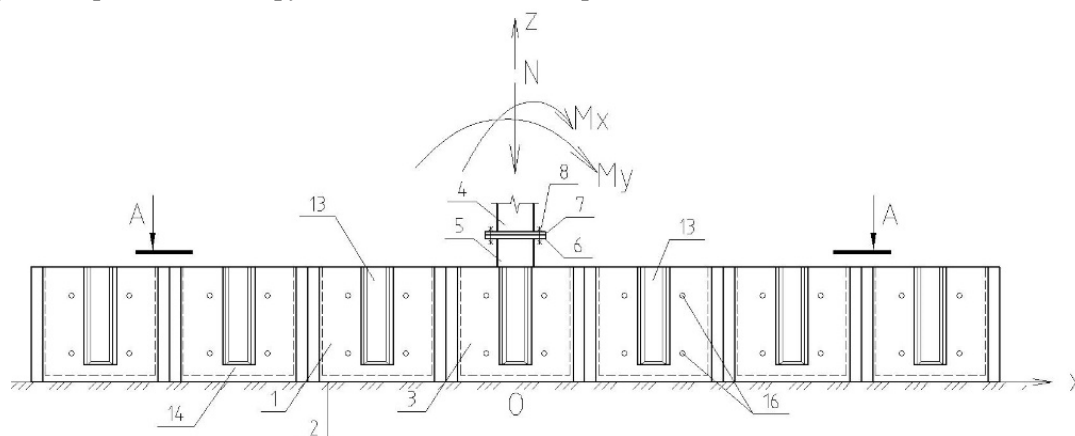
Фронтальный вид модульного фундамента под опору со схемой приложения нагрузок
